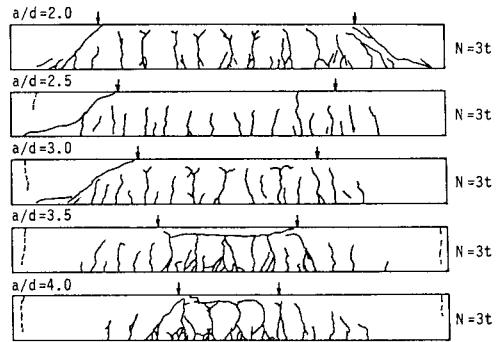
せん断スパン比をパラメータとした破壊時のひび割れ図
